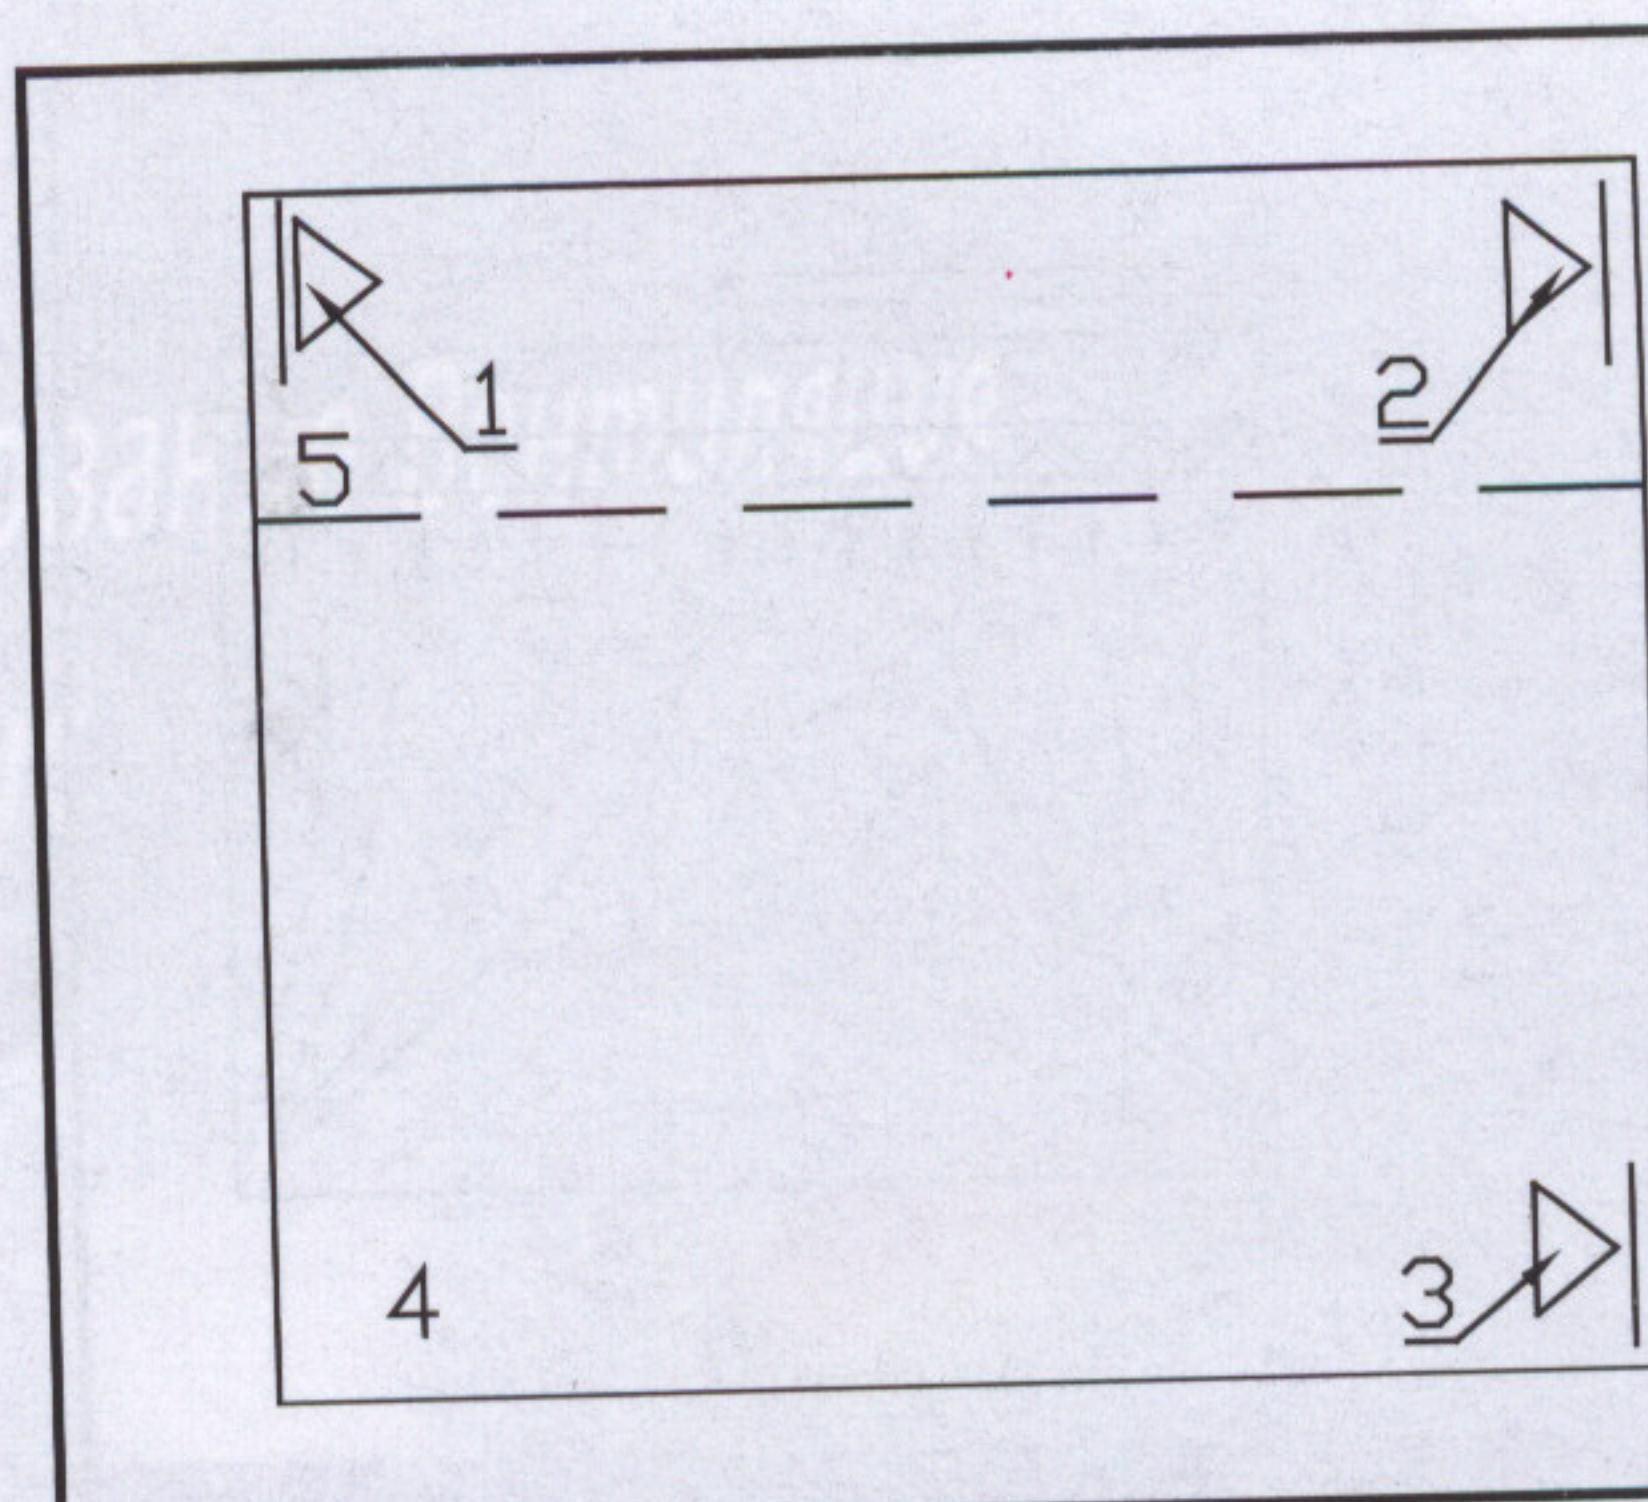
Схема удаления воздуха из верхней и нижней зон помещения:
